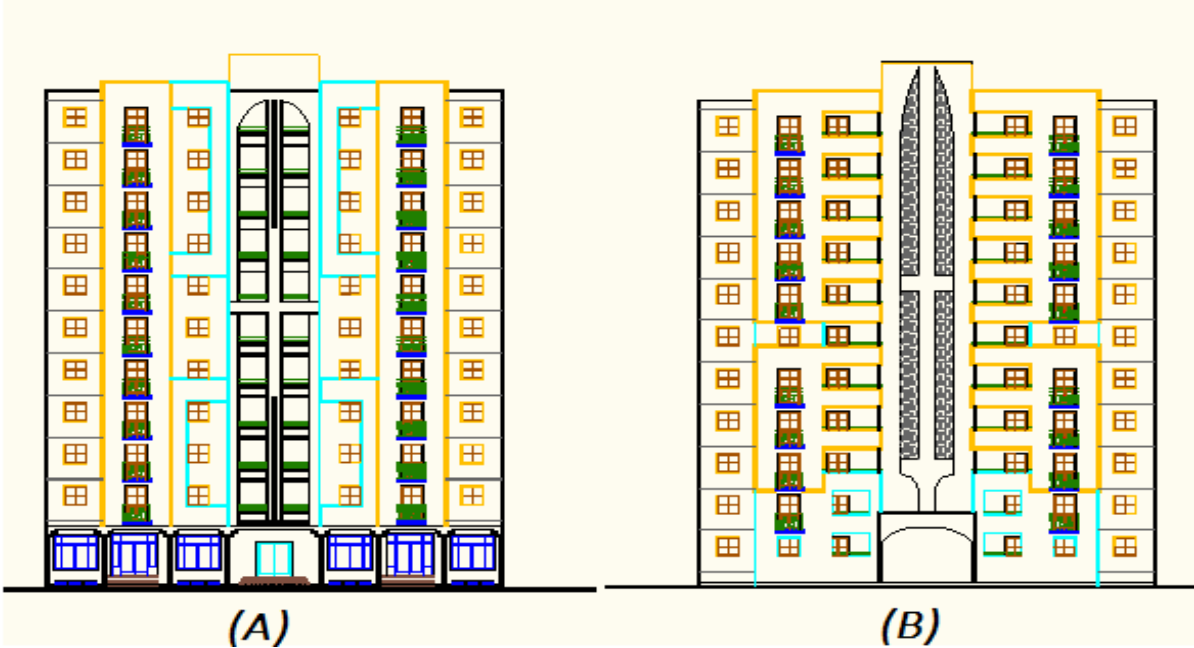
(A) Plan façade principale, (B) plan façade secondaire.
